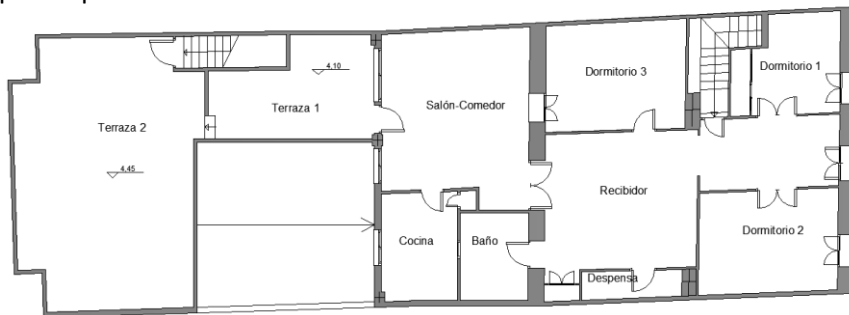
Distribución actual de la vivienda de planta primera. 2014.
